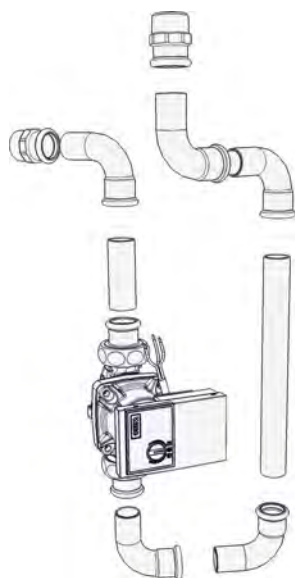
Tuyauterie de la pompe de la chaudière
